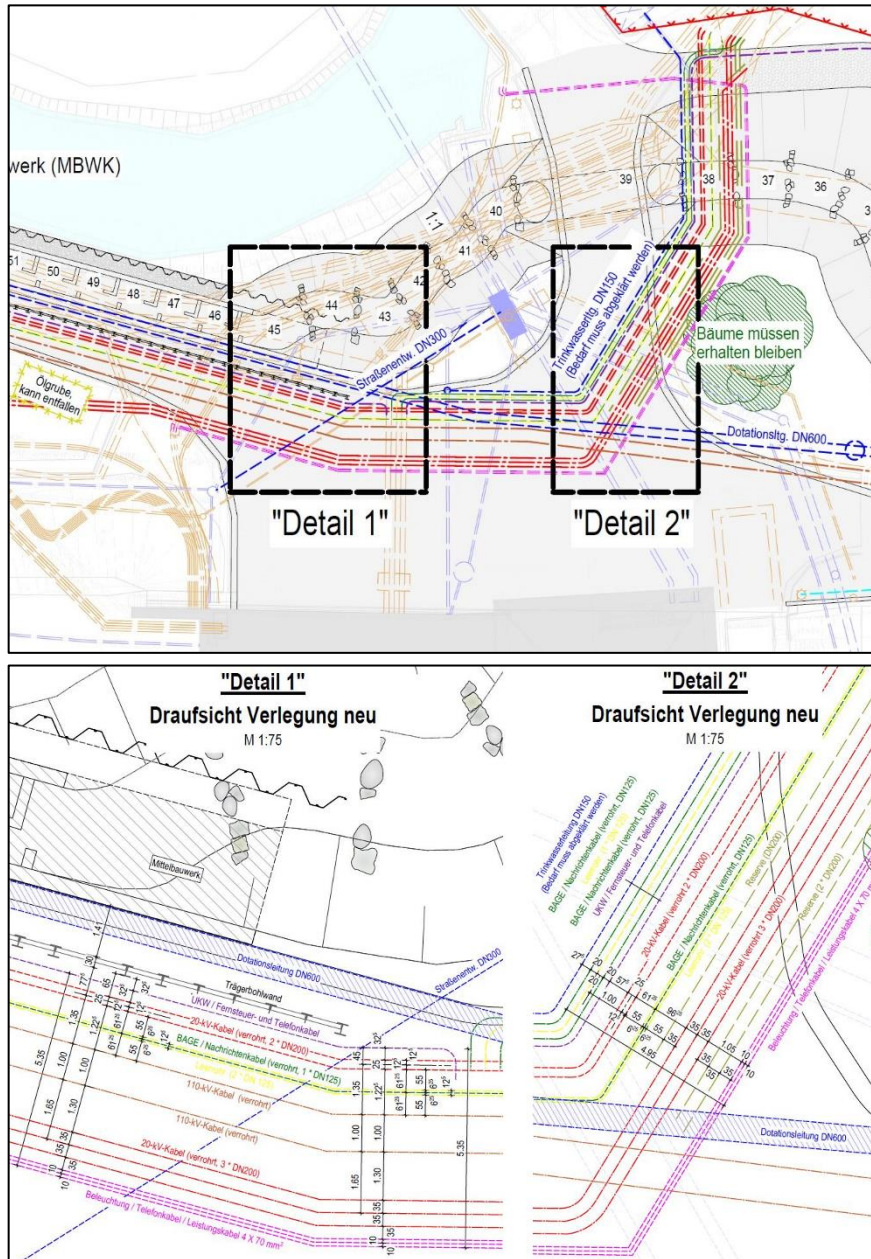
Ausschnitte des Spartenplans (Verlegung) im Bereich des KW-Vorplatzes (oben) mit Detailansicht (unten)
